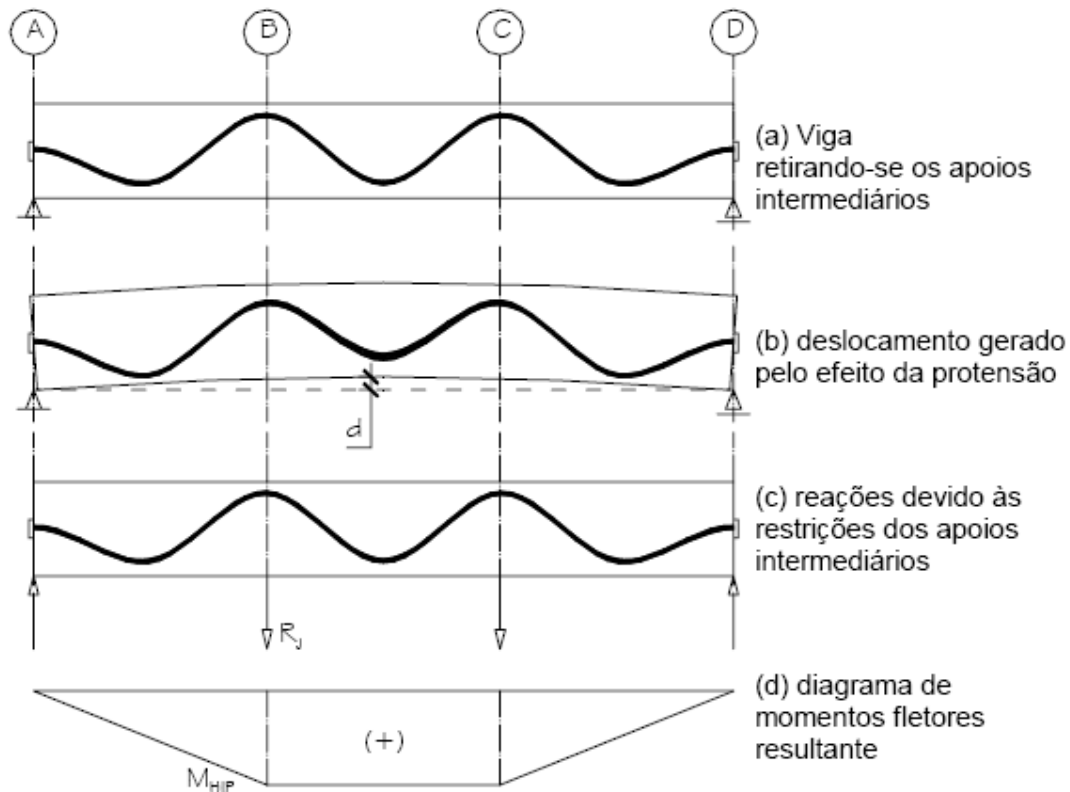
Efeito Hiperestático de Protensão apenas para vigas
